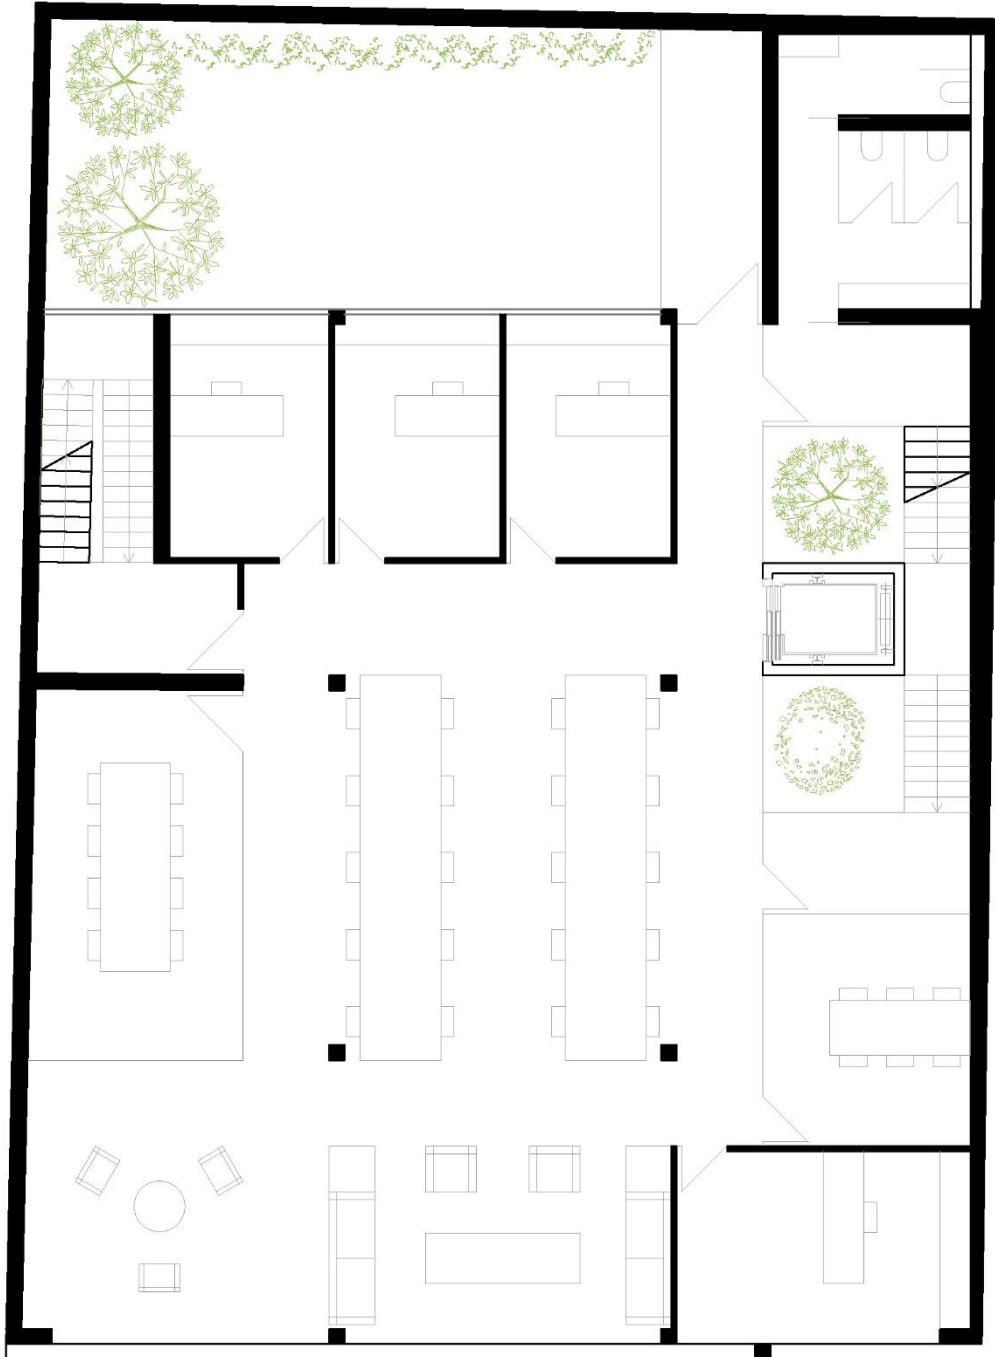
Encaje de proyecto, planta 1. Fuente: Elaboración propia.
